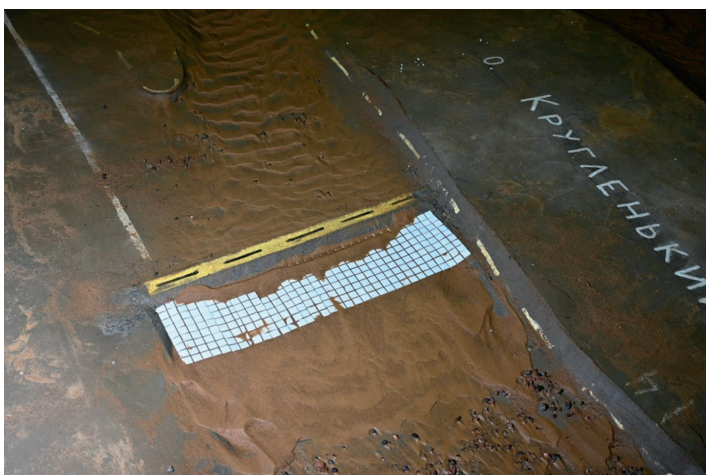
Вид на поперечную запруду с укреплением нижнего бьефа имитацией железобетонных матов
